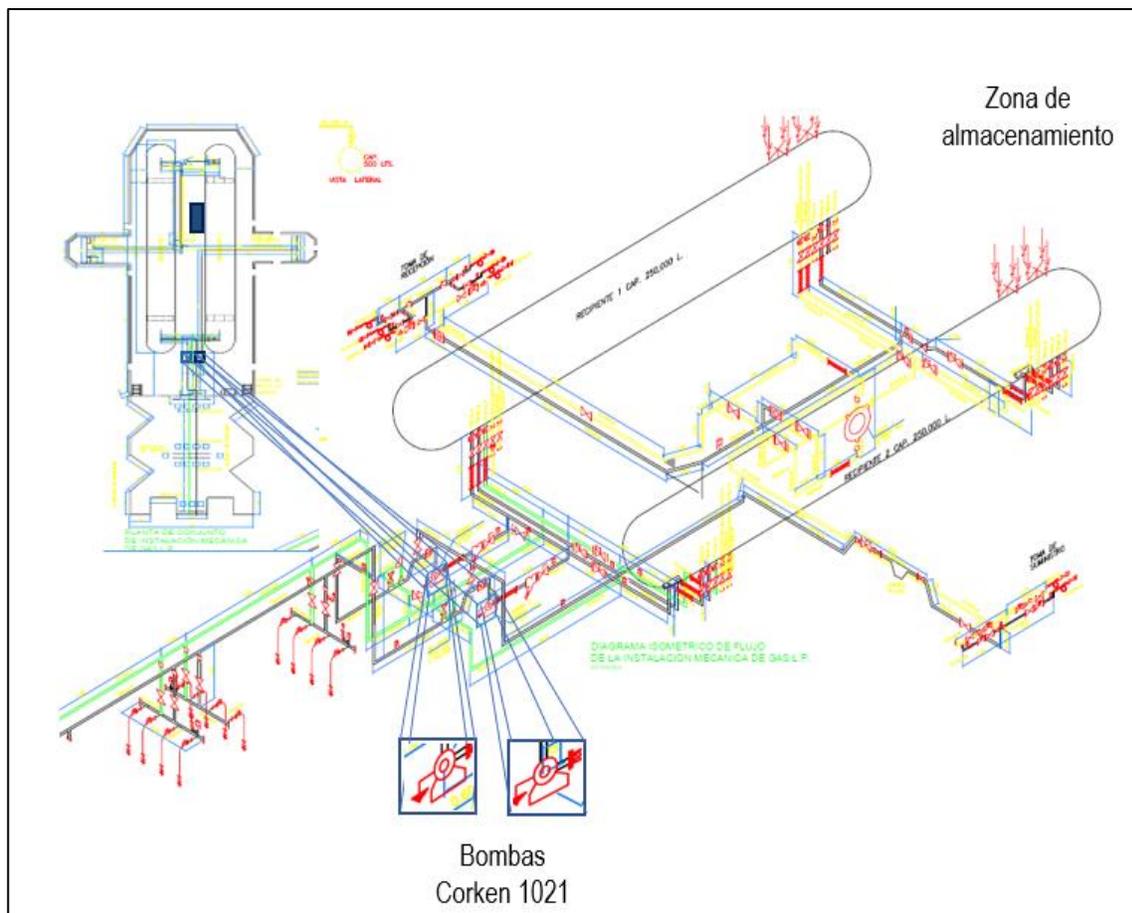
Localización en planta de los equipos de impulsión (bombas). Adaptación del plano mecánico de la planta.
